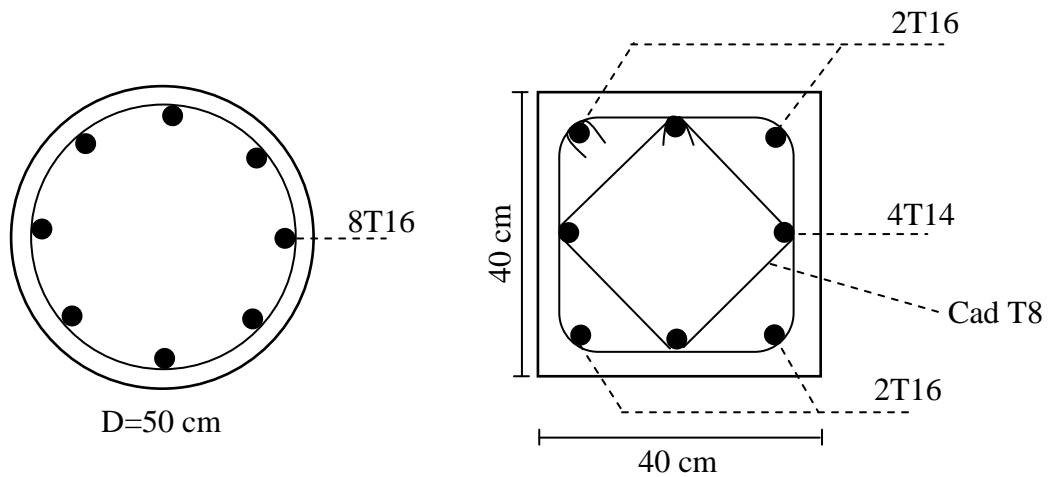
Dessin de ferrailages des sections des poteaux RDC et Terrasse
